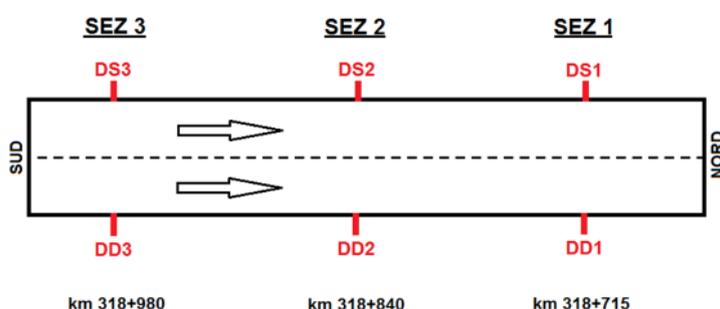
Posizione dei doorstopper nella pianta della galleria
